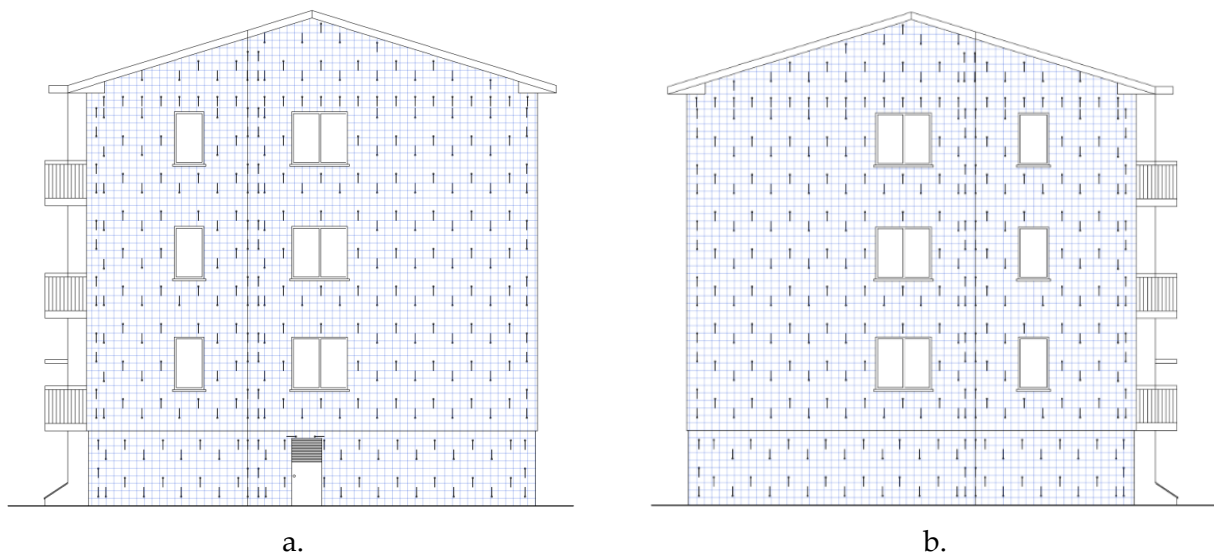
Intonaco armato con rete elettrosaldata su due lati: a) prospetto nord; b) prospetto sud.
